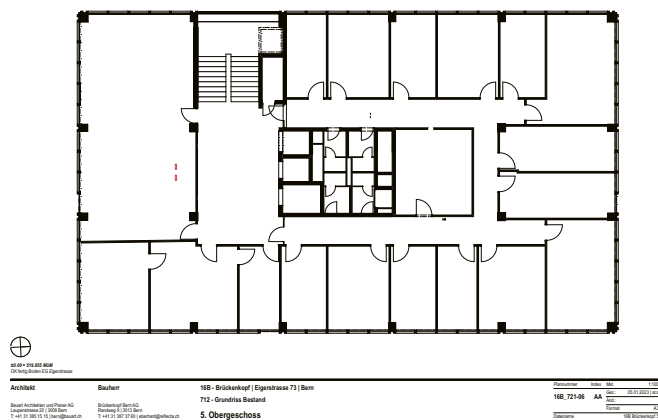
Grundriss 5. Obergeschoss Bestand
